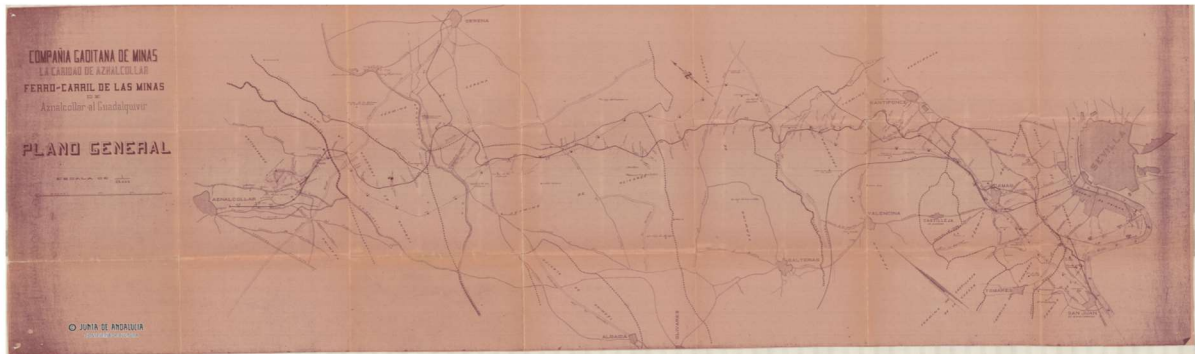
Plano General del Ferrocarril de las Minas de Aznalcóllar al Guadalquivir (Fuente: Archivo Histórico Provincial de Sevilla)
